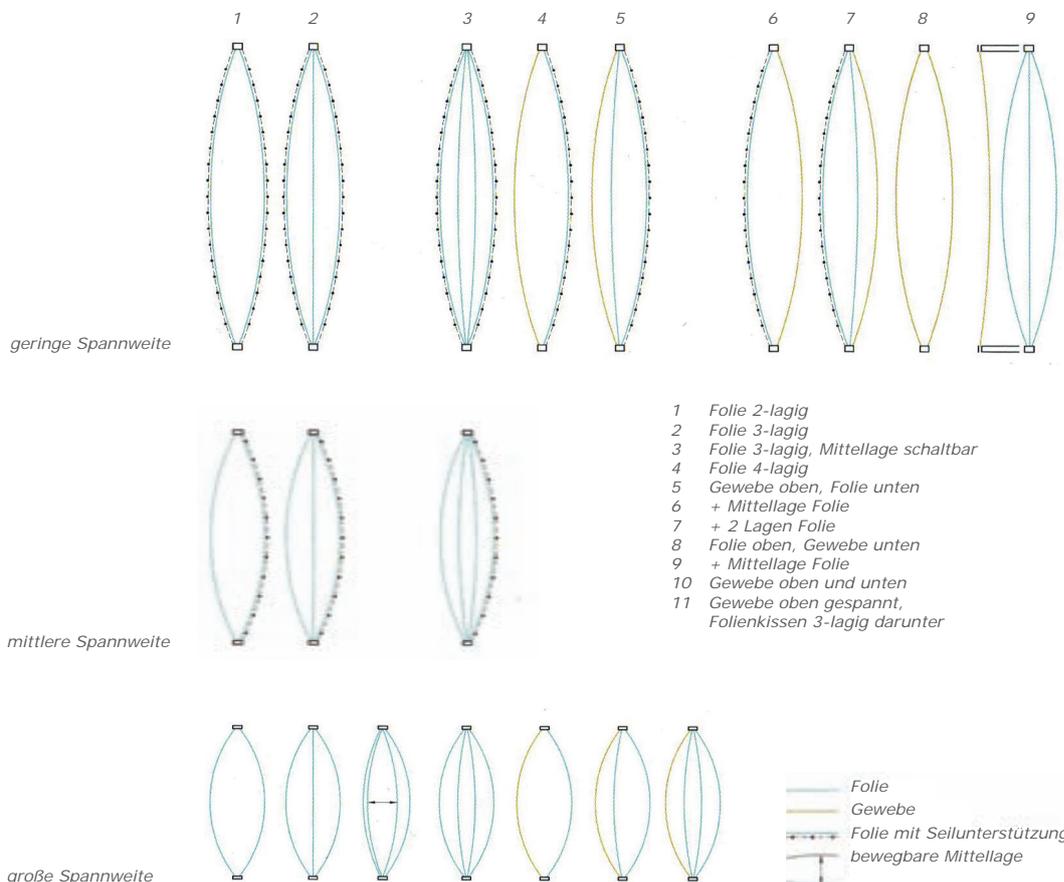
Übersicht Folienkissen nach Spannweite und Lagenaufbau
